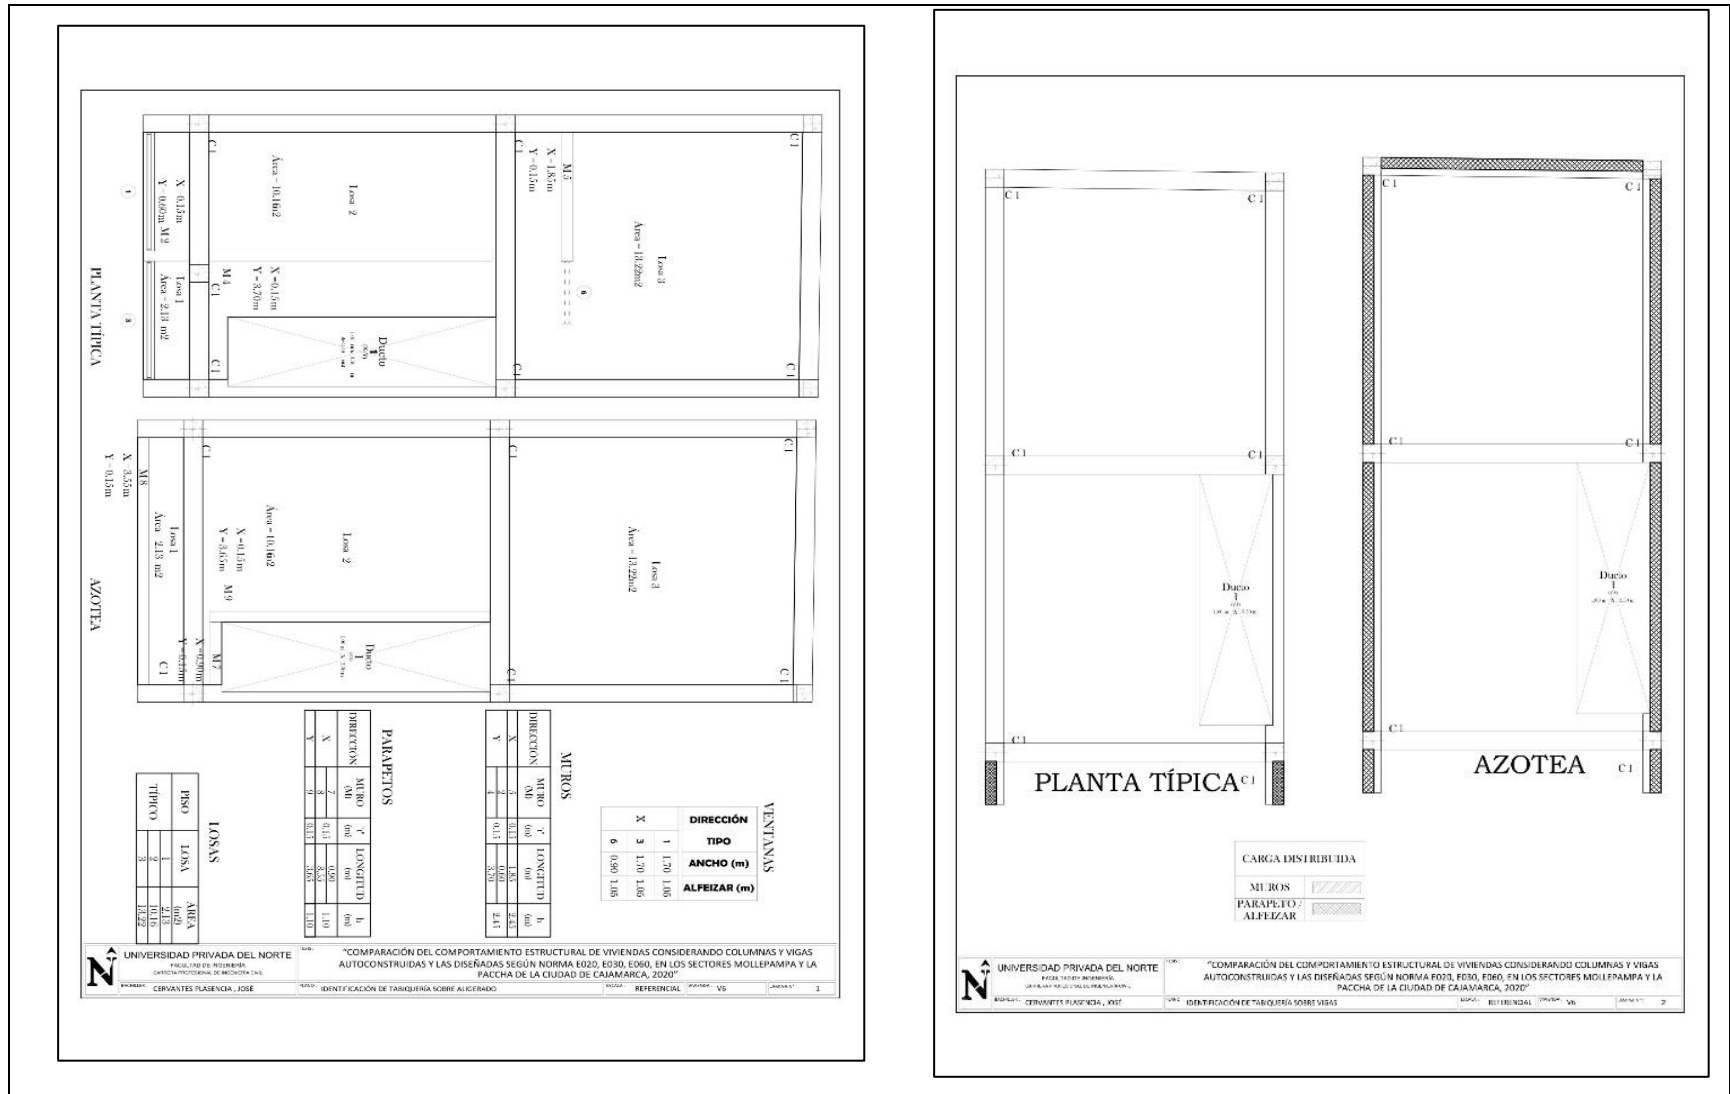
Tabiquería sobre losa aligerada y vigas vivienda 6
